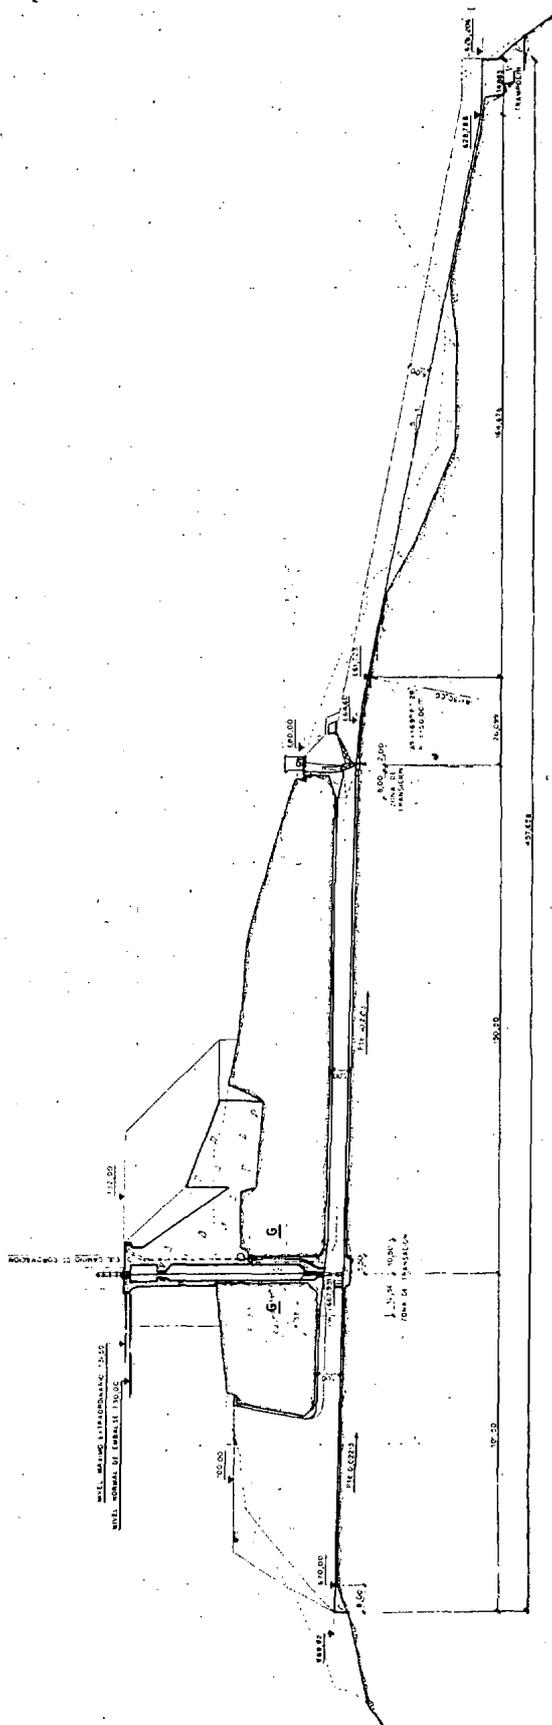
Desagüe de medio fondo. Perfil longitudinal (Medium deep outlet. Longitudinal profile.)
